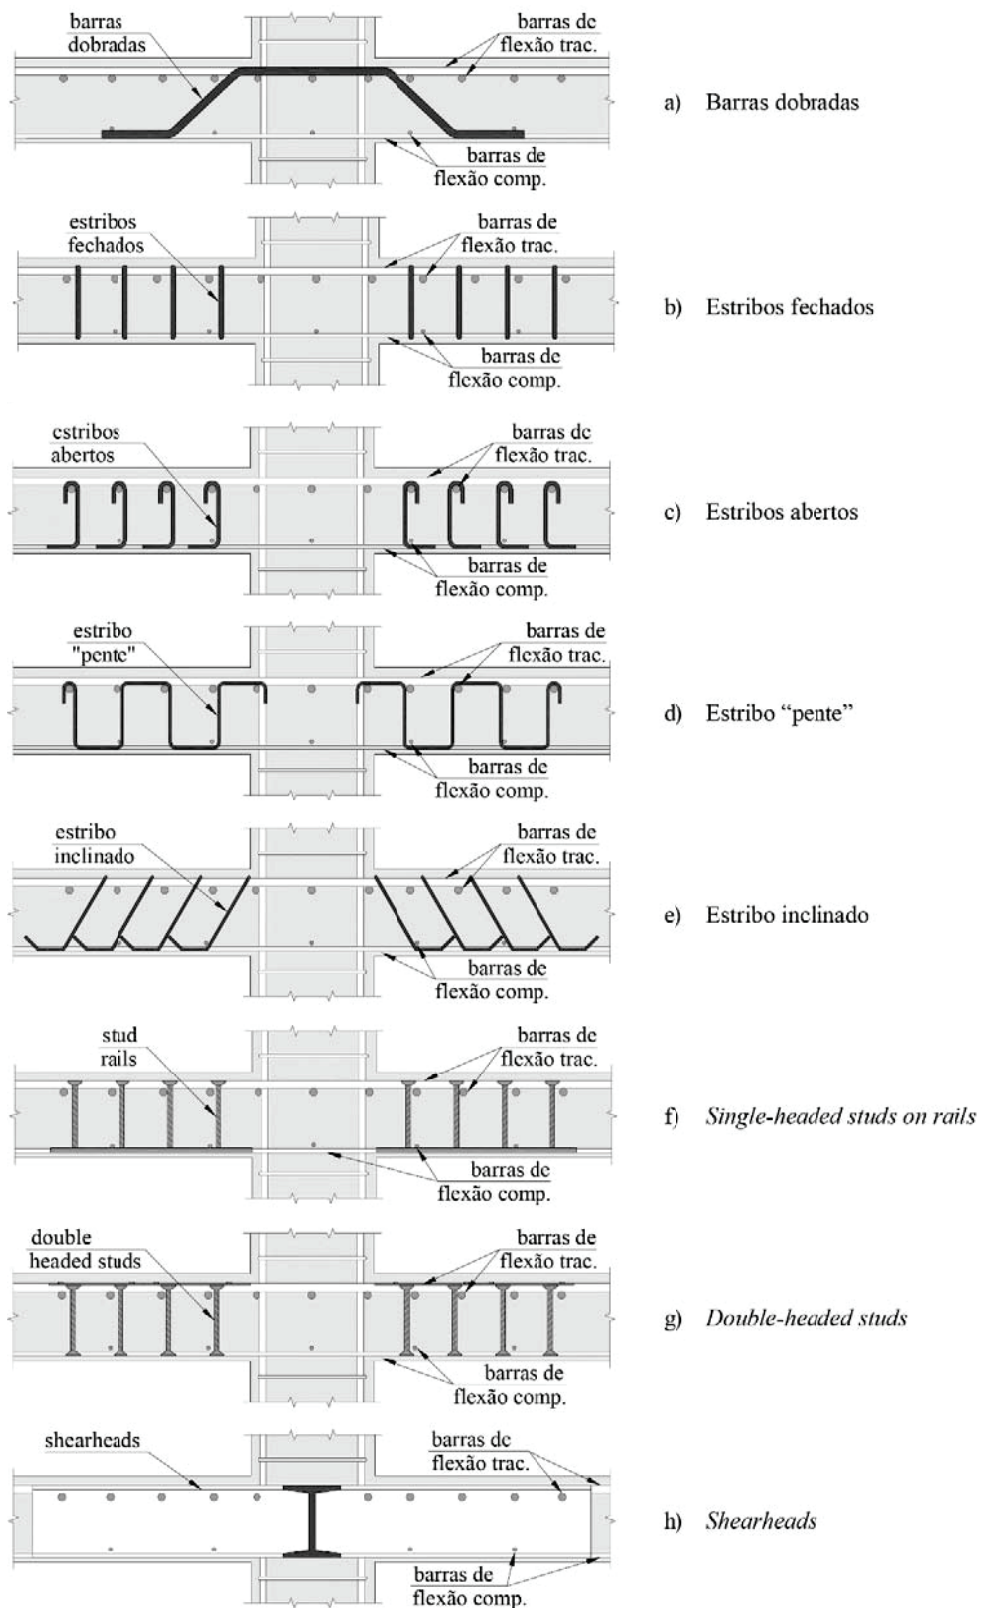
Arranjos para a distribuição da armadura de cisalhamento tipo studs
